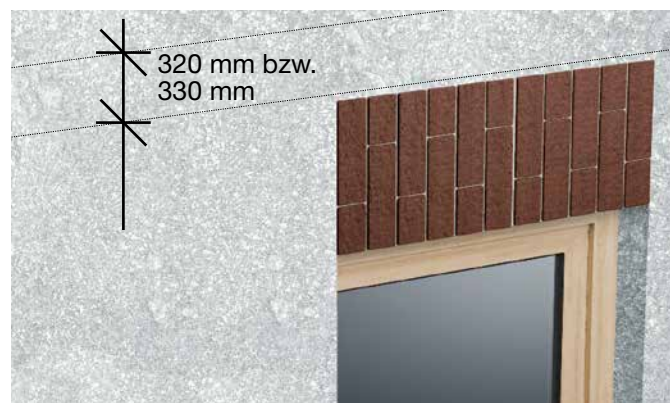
Вертикальная раскладка плиток над верхом оконных проемов.
